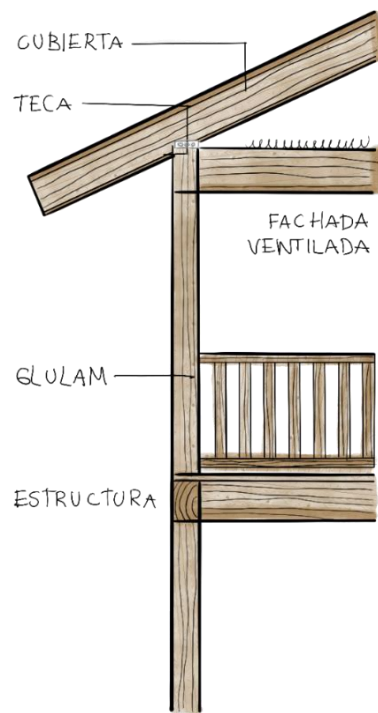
Detalle constructivo de la cubierta con base a la información extraída anteriormente- Autoría propia
